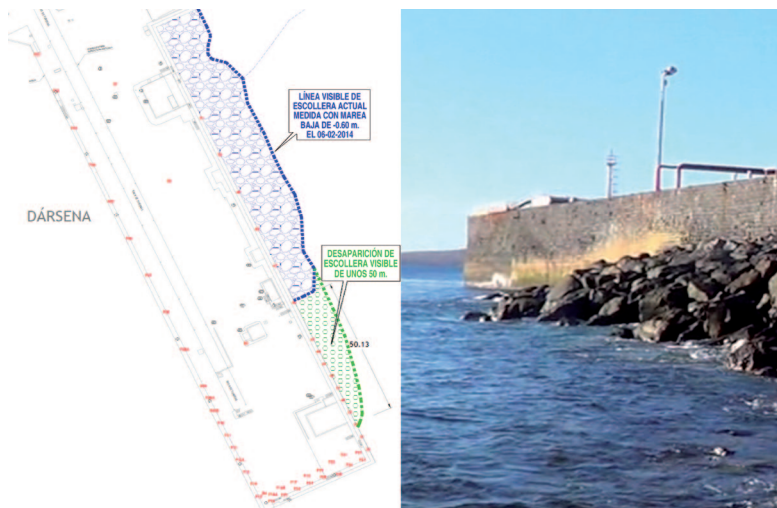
Vista en planta y vista general tras el temporal de enero de 2014.
